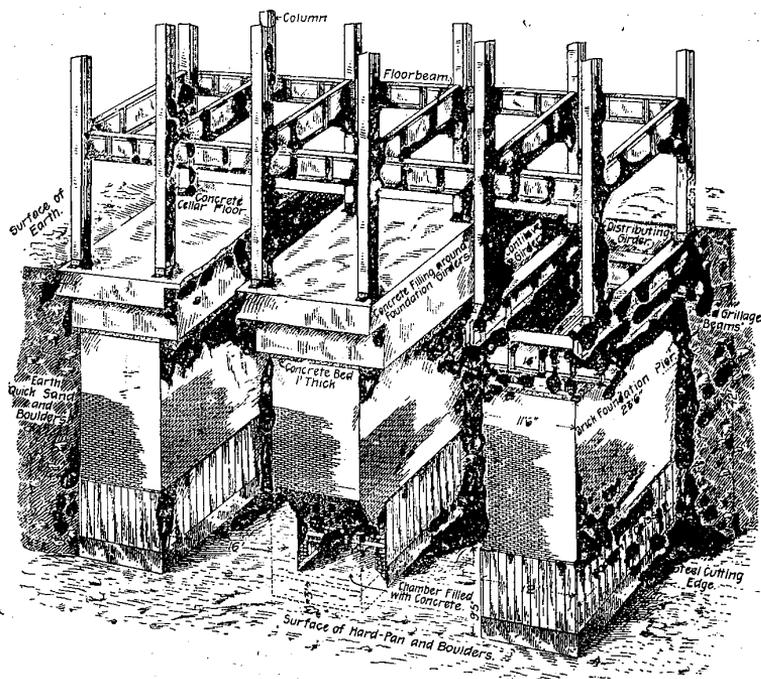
Fondations sur caissons à l'air comprimé du Giltender's Building. (V. fig. 10).
